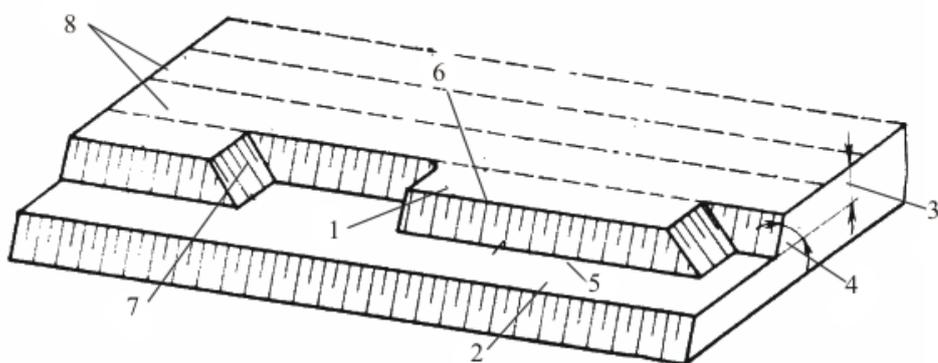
Элементы уступа: 1- верхняя площадка уступа; 2- нижняя площадка уступа; 3- высота уступа; 4- угол откоса уступа; 5- нижняя бровка уступа; 6- верхняя бровка уступа; 7- забой; 8- заходка.
